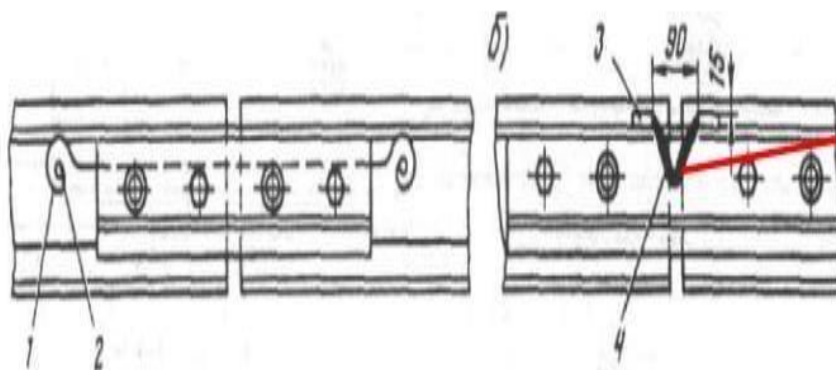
Рельсовые соединители: а) штпсельный; б) приварной;
